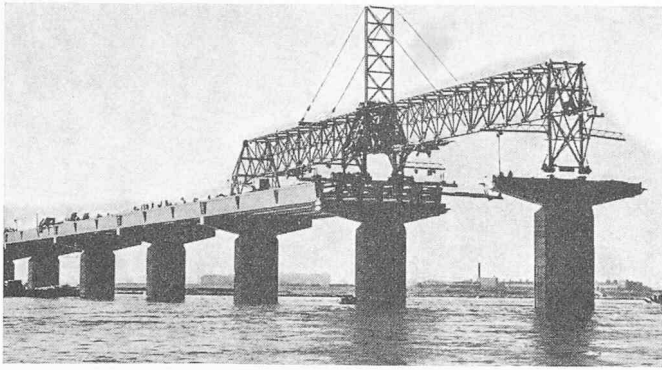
Stählerne Fachwerkbrücke zur Montage von Spannbetonbalken für die St. Lawrence River-Brücke, Kanada
